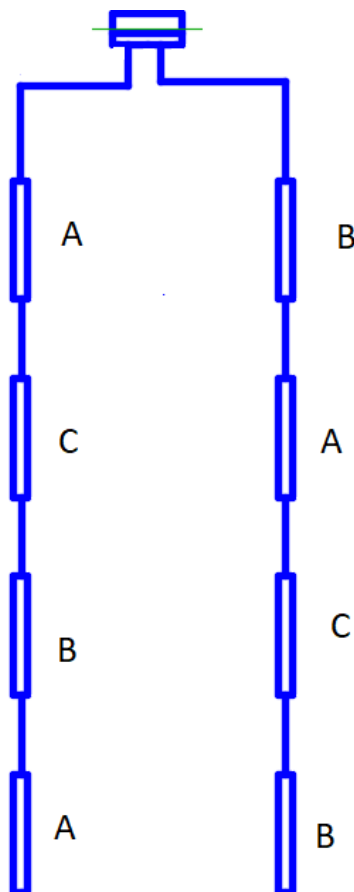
Схема питания светильников от щитов освещения в котельной
